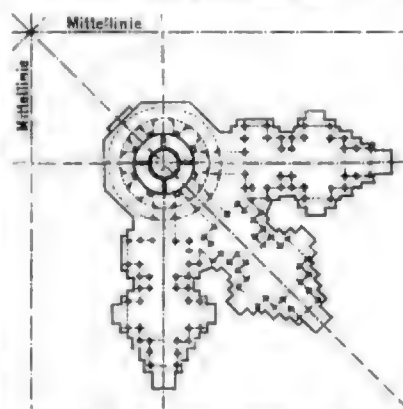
Theil vom Grundriss zu Abb. 3.
